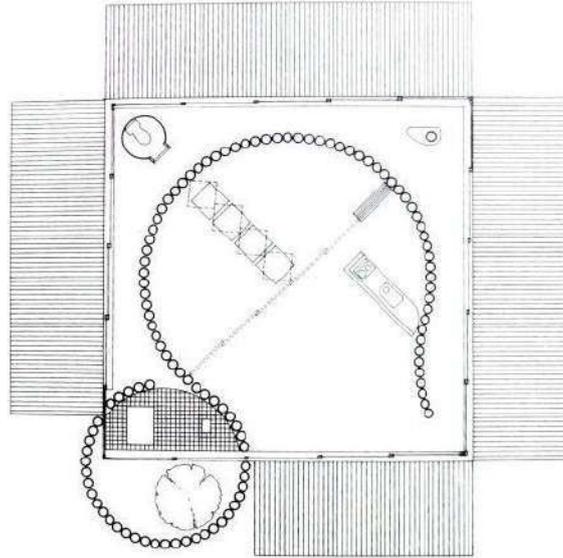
Planta de la vivienda, *Paper House*. Disponible en: <https://www.pinterest.es/pin/438889926186529910/>
